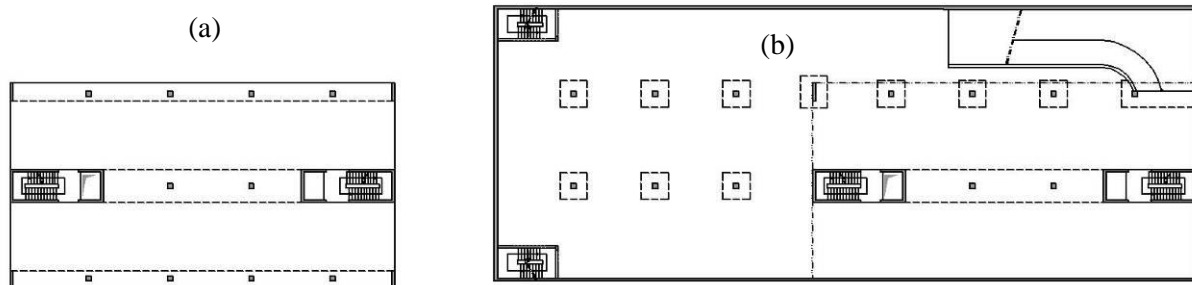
Plantas de um edifício com restrições à deformação livre, dos pisos superiores (a) e enterrados (b)
